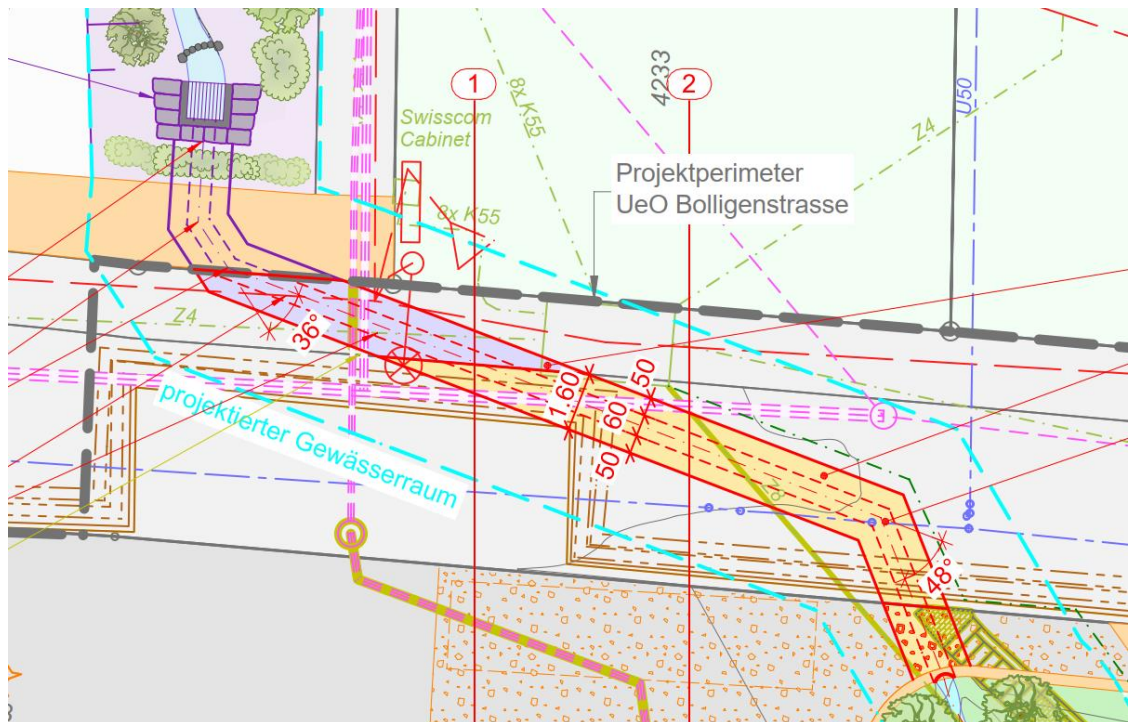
Ausschnitt aus Situationsplan: Detailansicht Fassung ab Einlaufbauwerk Stegackerweg (siehe Plan 33.611)
